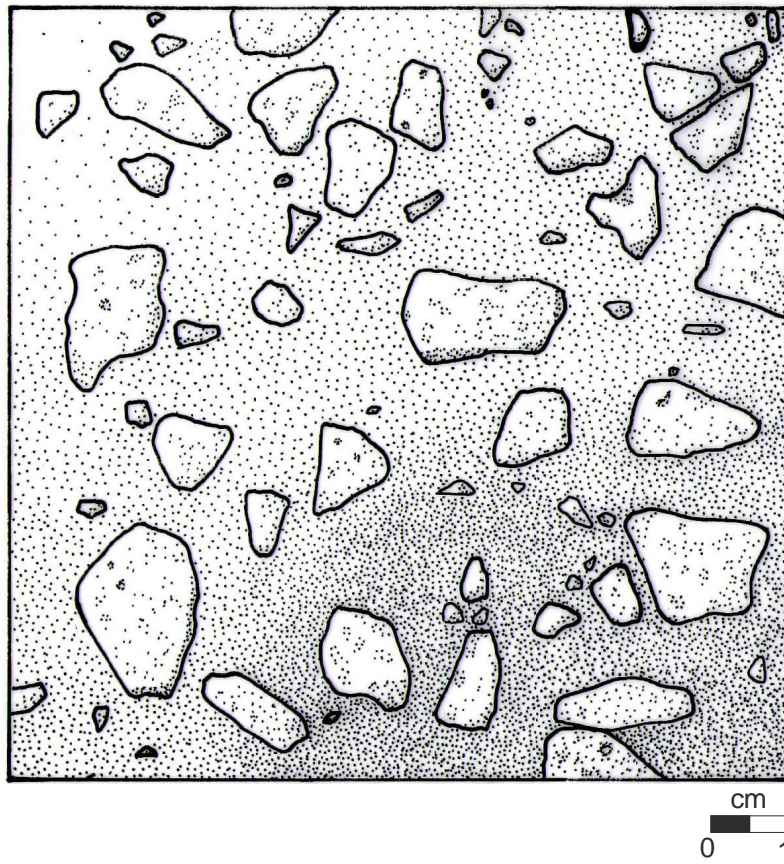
Desenho do aparelho construtivo da calçada da via da Póvoa.
